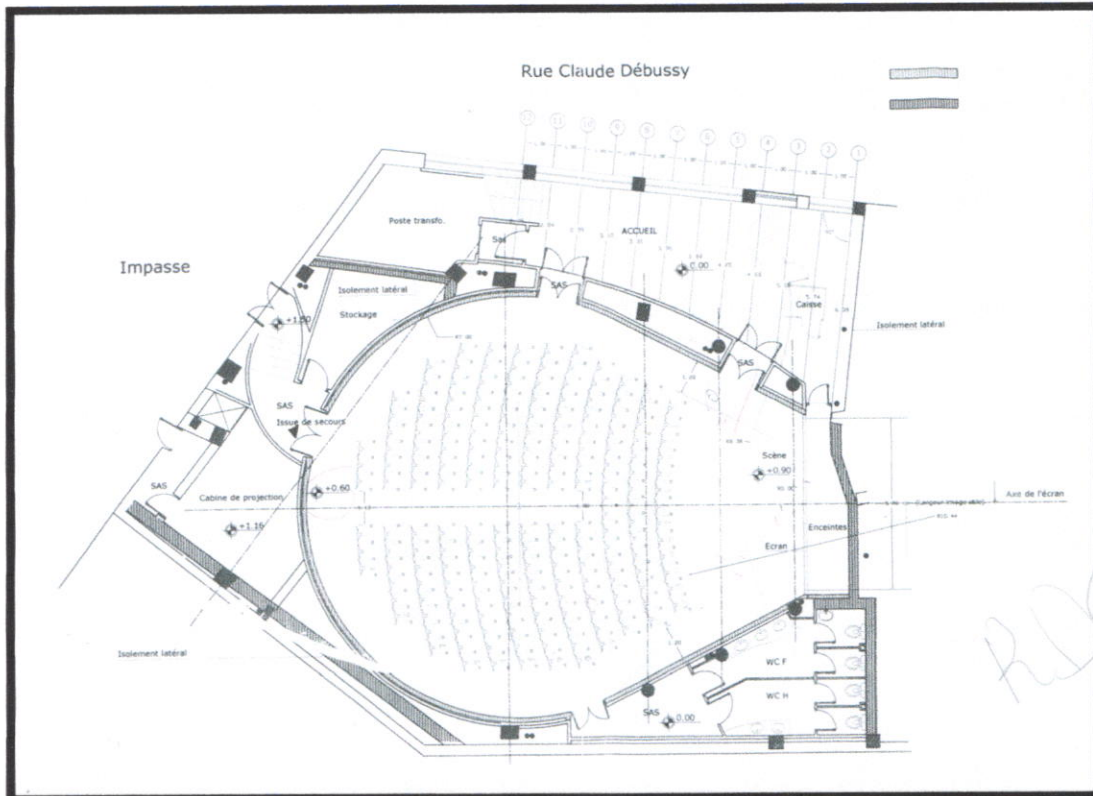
Plan RDC de la salle de cinéma el khayam, source : la mairie d'Alger
